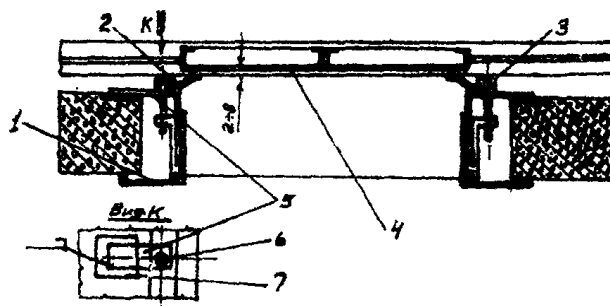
Установка алюминиевого обрамления с креплением к закладным деталям:
